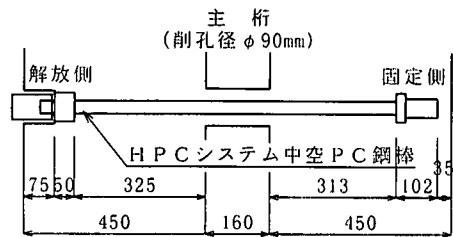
HPCシステム中空PC鋼棒配置図 (寸法単位: mm)
